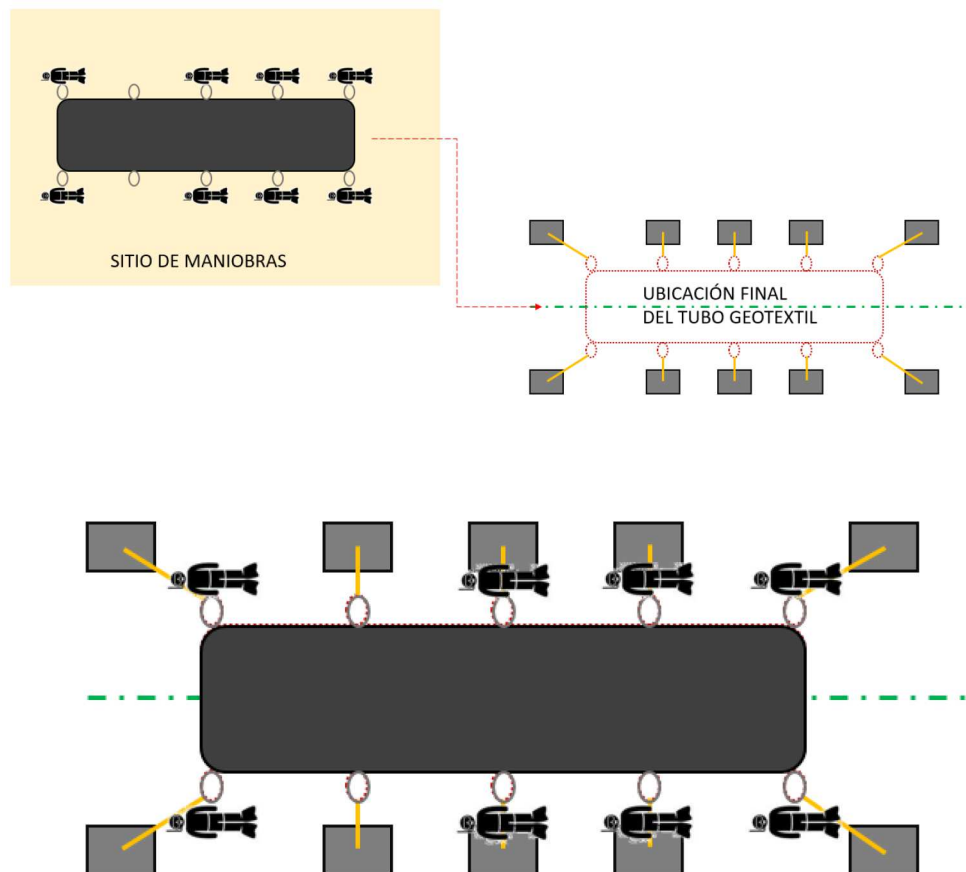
Esquema del sistema de anclaje de los tubos geotextiles.
